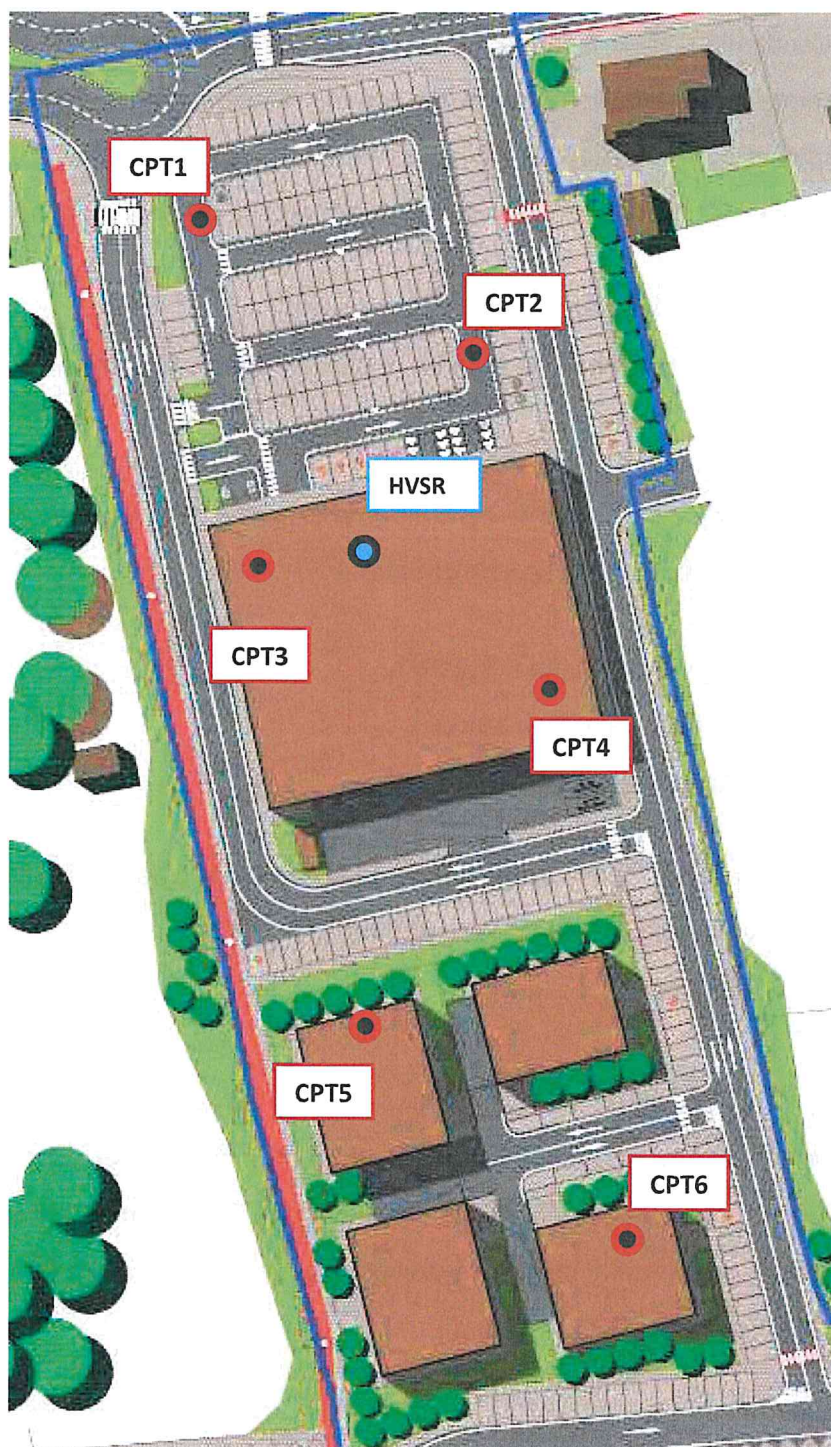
Ubicazione delle indagini eseguite rispetto allo stato di progetto
